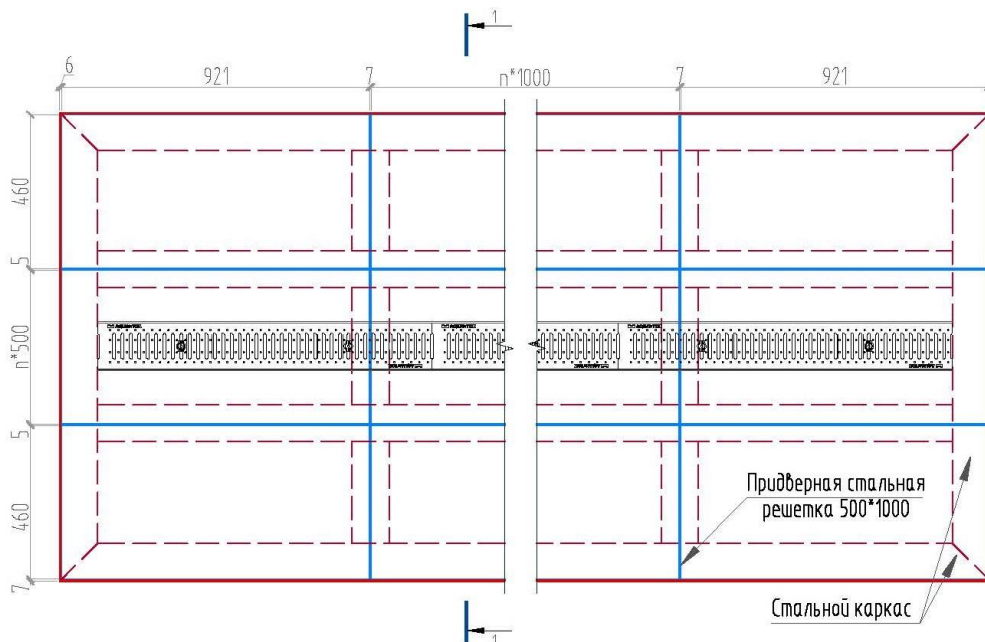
Два варианта укладки грязезащитного покрытия на опорную конструкцию HILTI.
